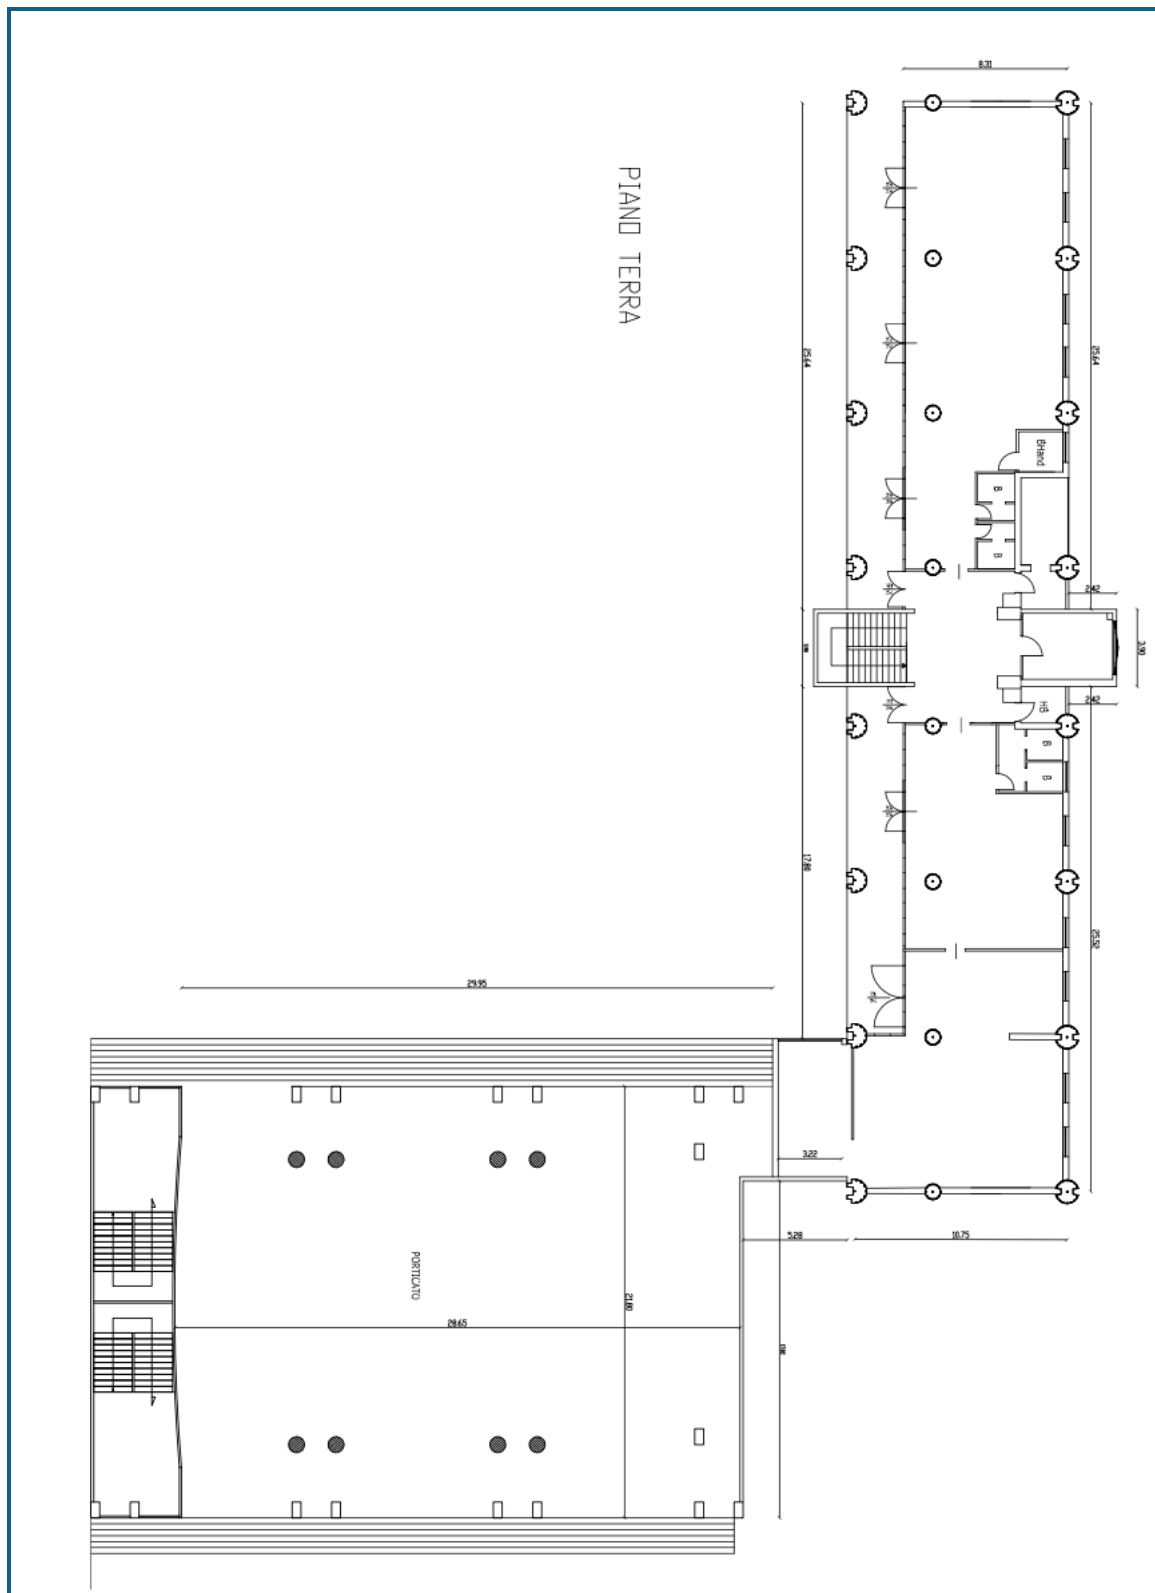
Planimetria Piano terra DICOMAC - RENDE
